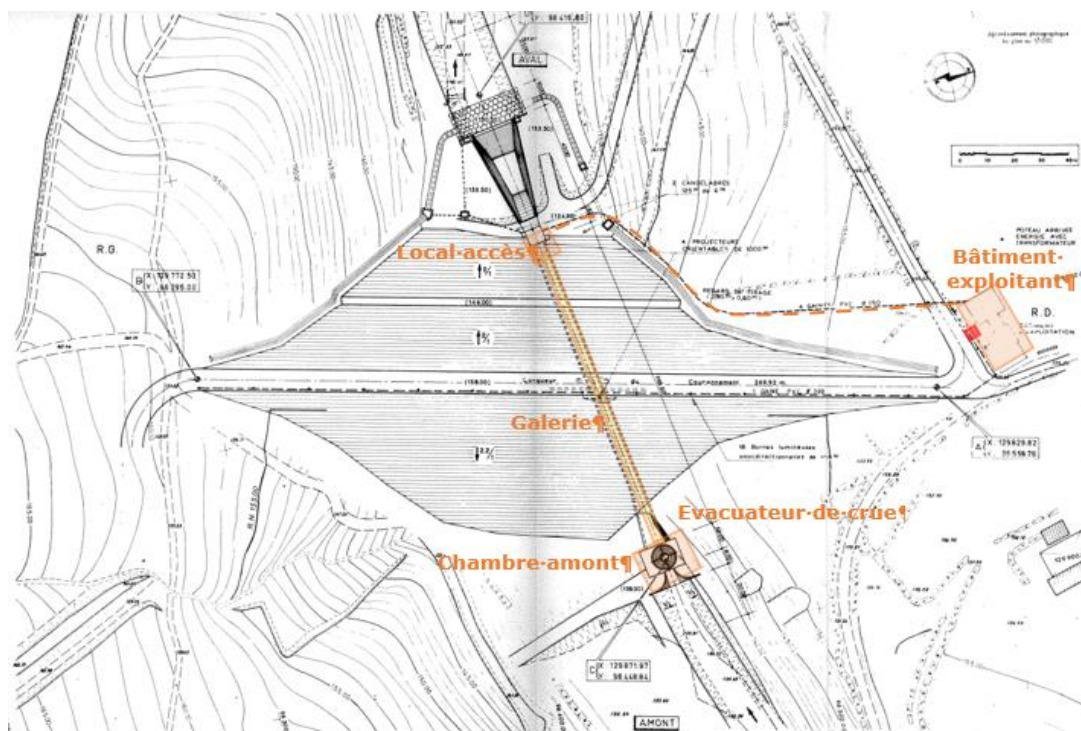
Plan d'ensemble de l'ouvrage et cheminement de cables (1981)
